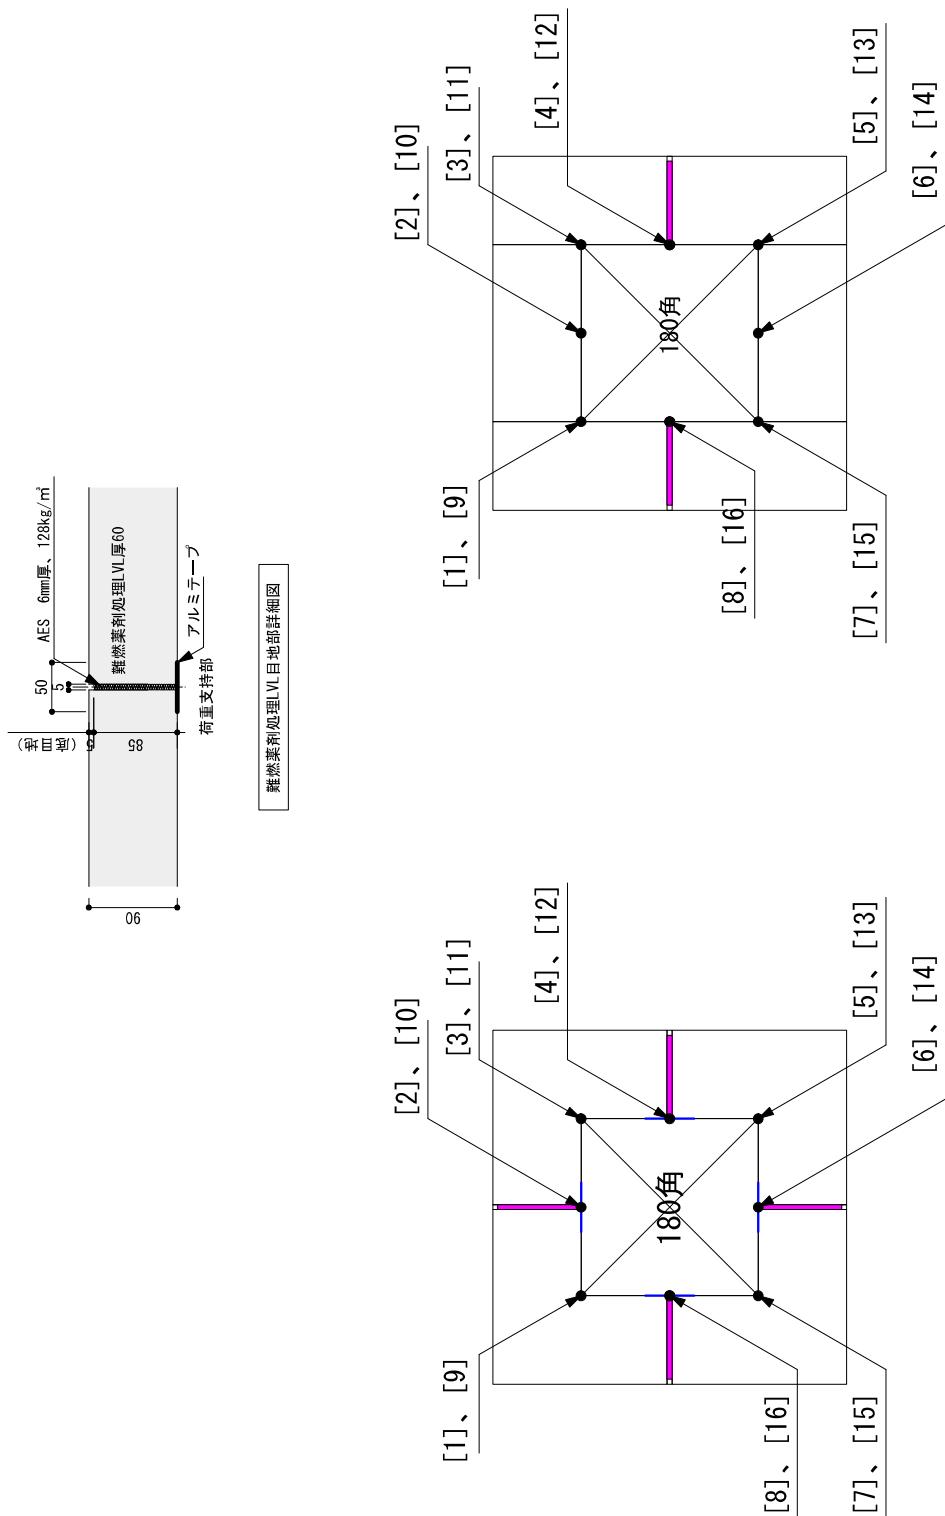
試験体の構造・寸法・内部温度測定位置 (寸法単位: mm)
